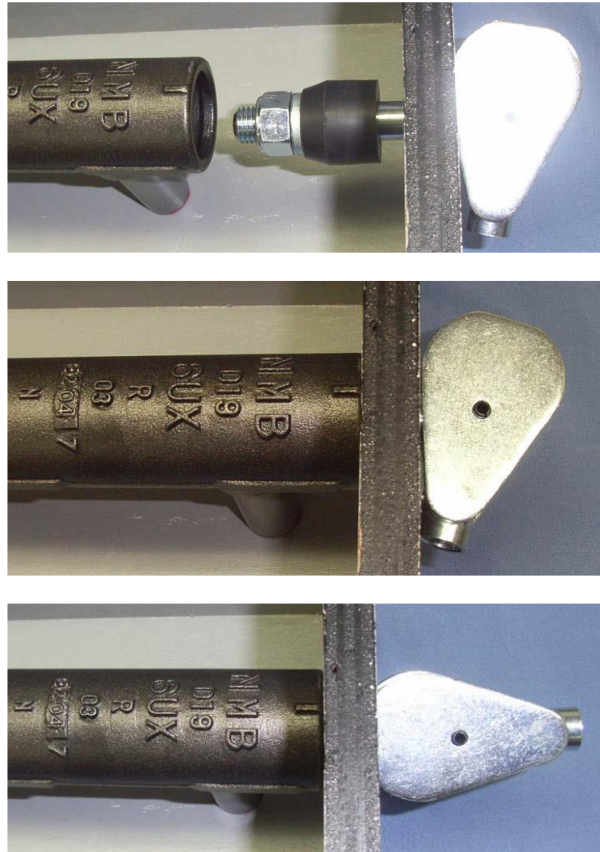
Proceso de posicionamiento del conector al moldaje utilizando el fijador. (Ref. 10)
